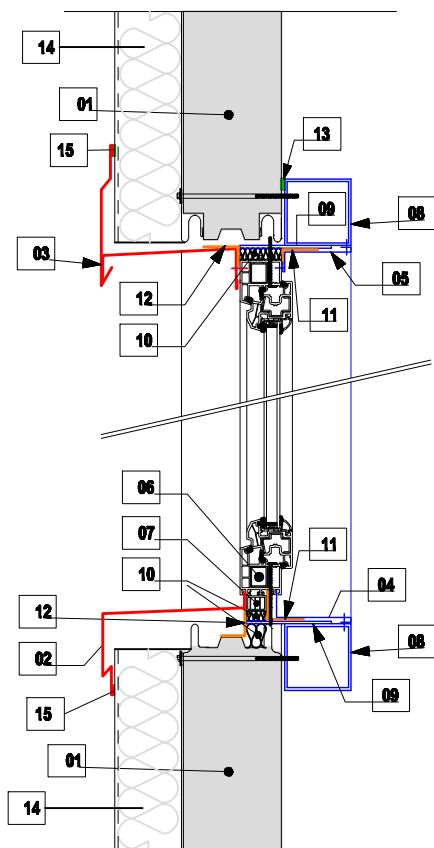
DETAIL OSADENIA OKNA - PARAPET A NADPRAŽIE
